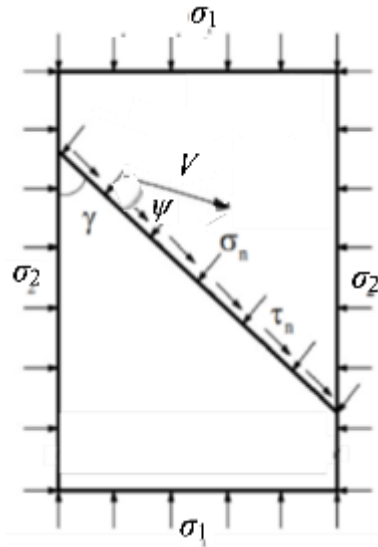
Кінематична схема руйнування бетонного елемента
